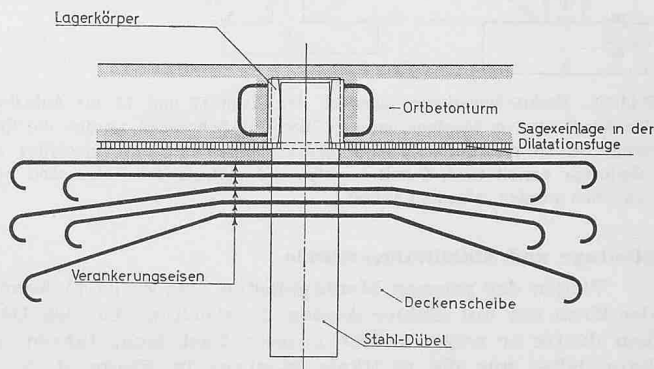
Anschluss des vorgefertigten Systems an die stabilisierenden Ortsbetontürme mit Hilfe von Stahldübeln. Diese sind so ausgebildet, dass eine horizontale und vertikale Verschiebung möglich ist (beweglicher Anschluss mit zwei Freiheitsgraden). Masstab 1:30
